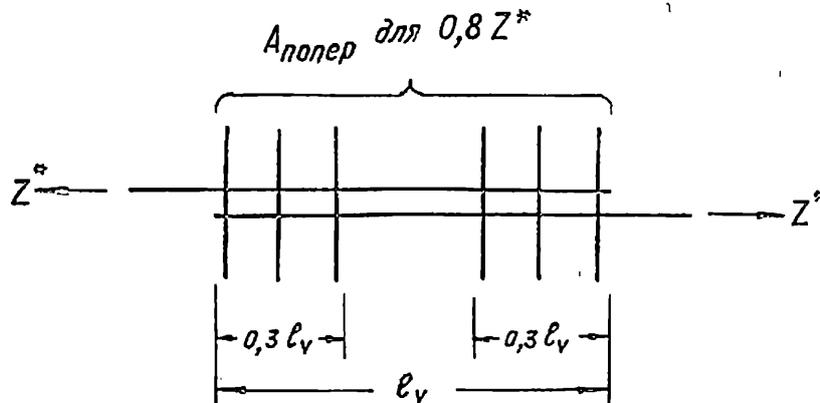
6. Расположение поперечной арматуры в стыках внахлестку
